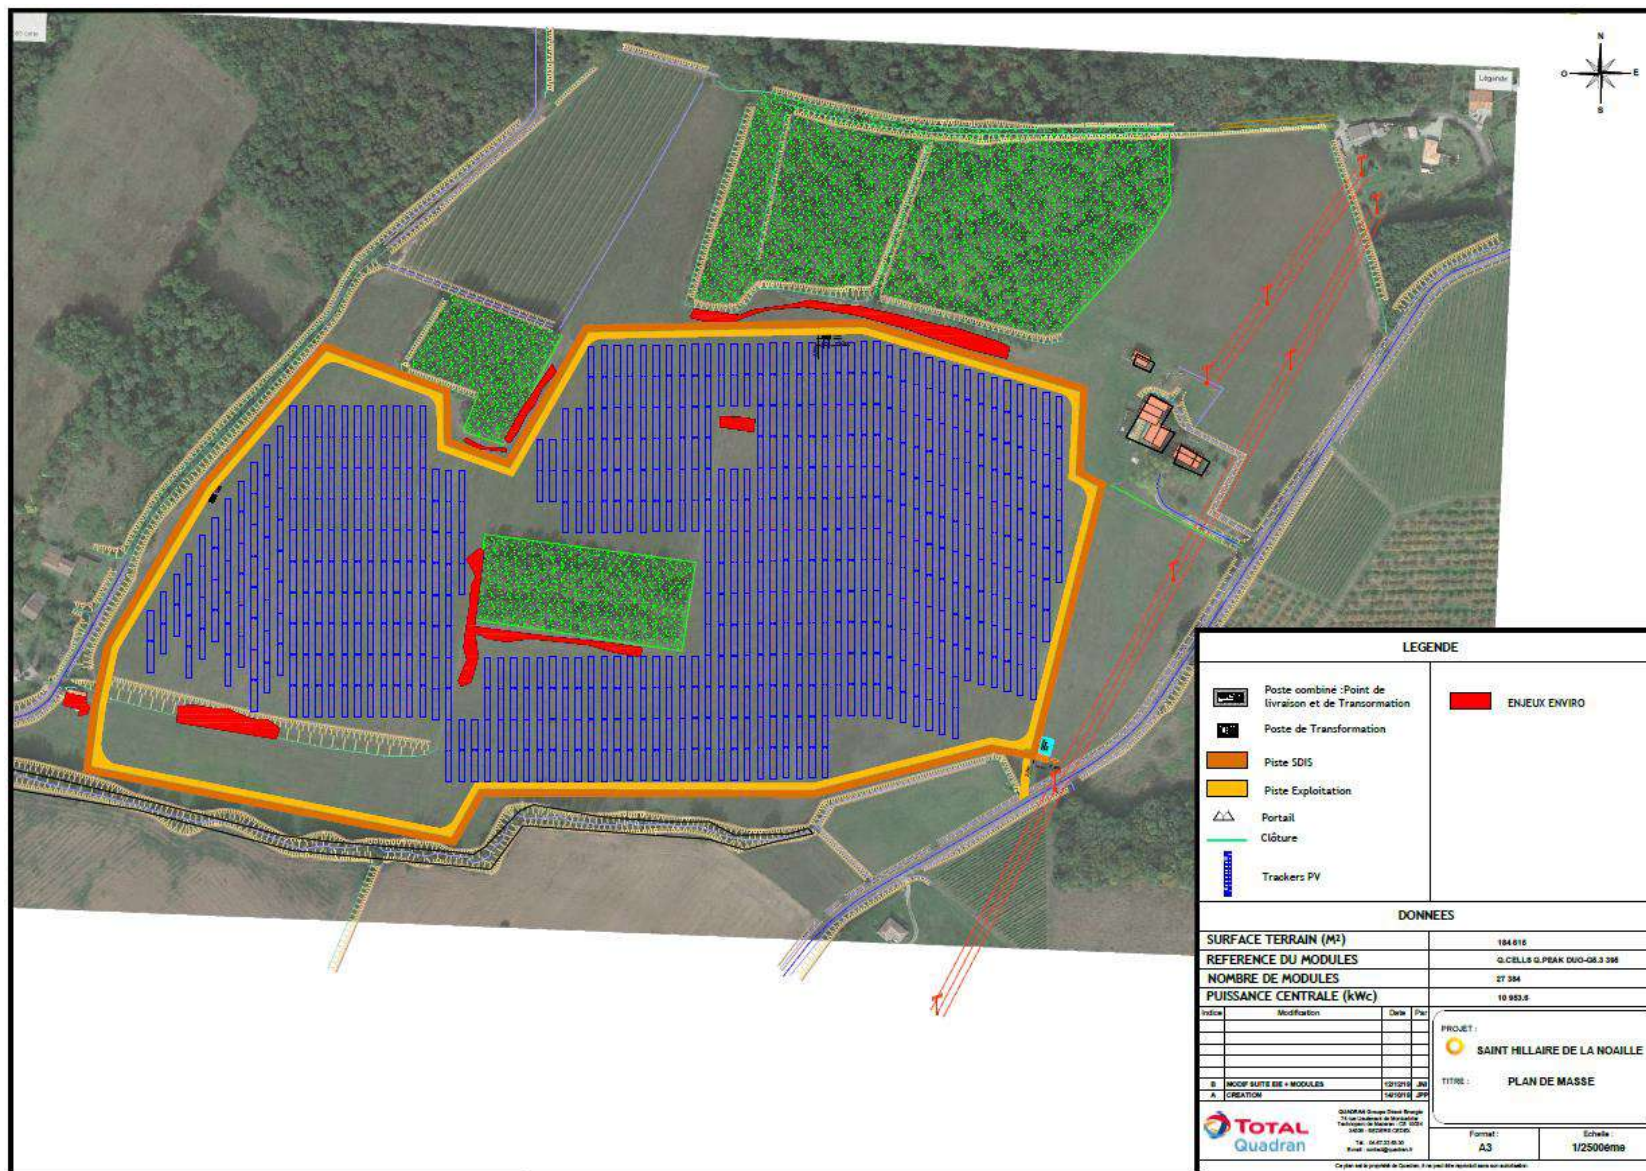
Plan de masse du projet (Source : Quadran – 12/12/2019)
